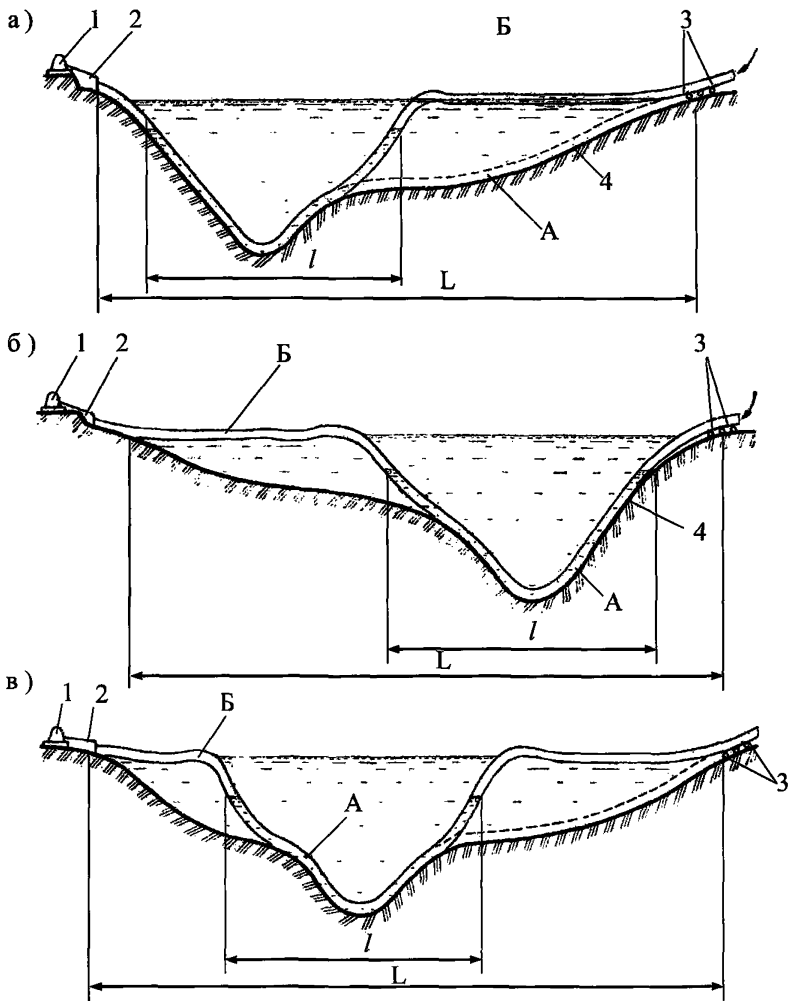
Схема укладки трубопровода с регулированием плавучести при различном рельефе дна:
